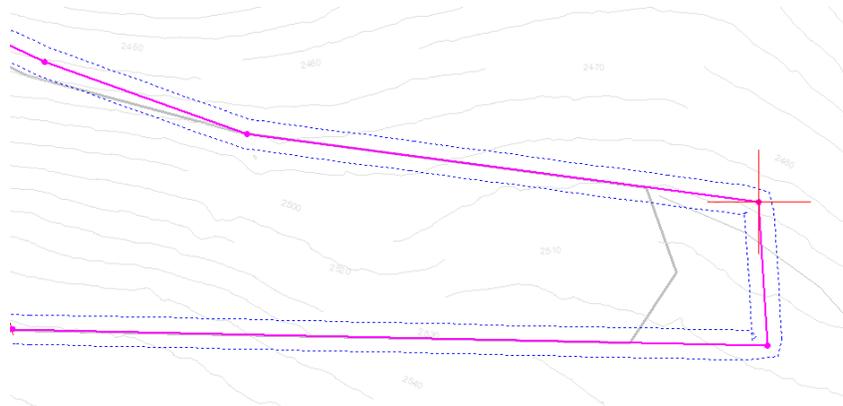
La horquilla después de agregarle otro IP en la parte superior
